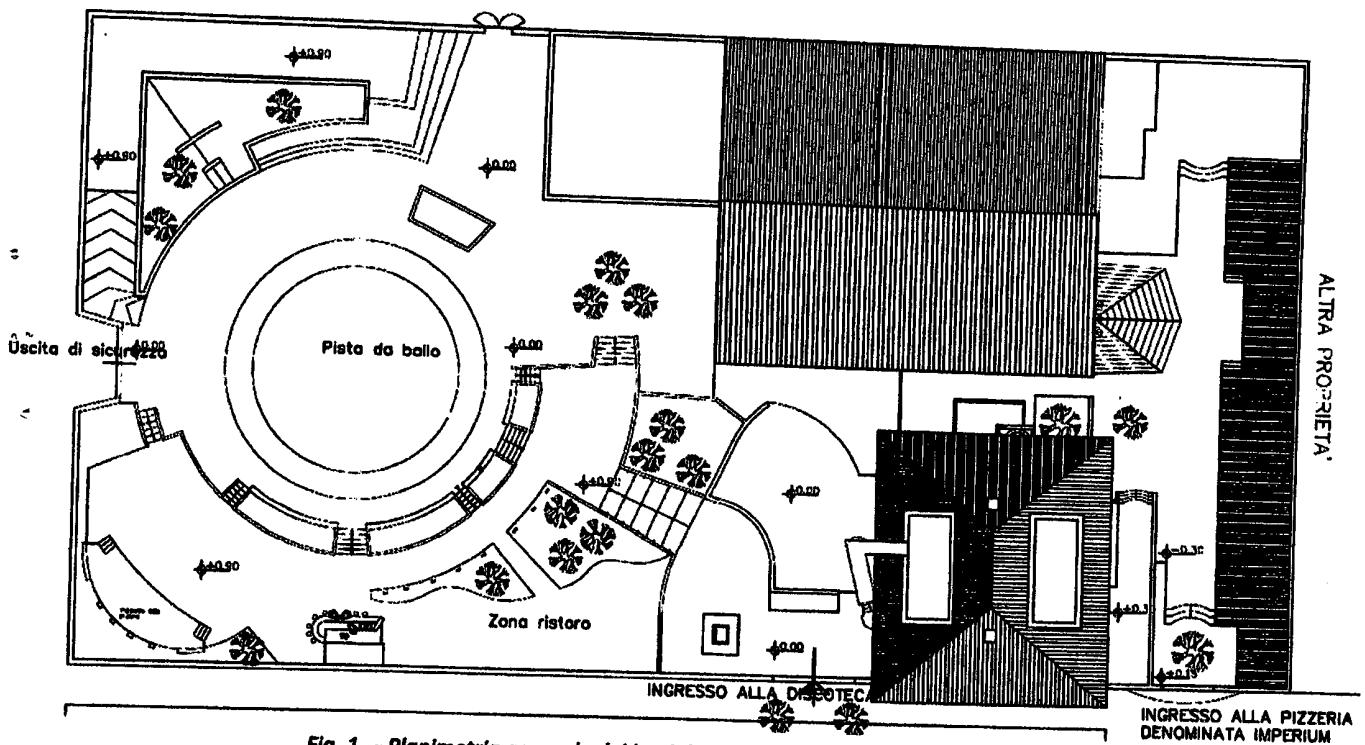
Planimetria generale dei beni di c.da Roccazzelle
